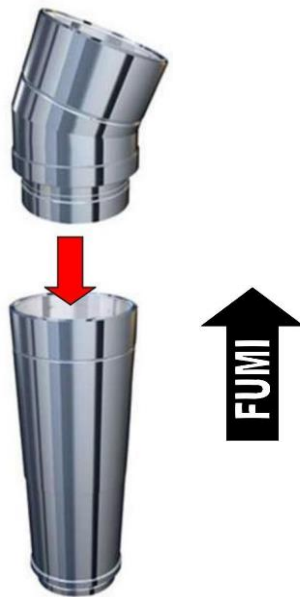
Esempio di innesto maschio-femmina e direzione fumi da rispettare
